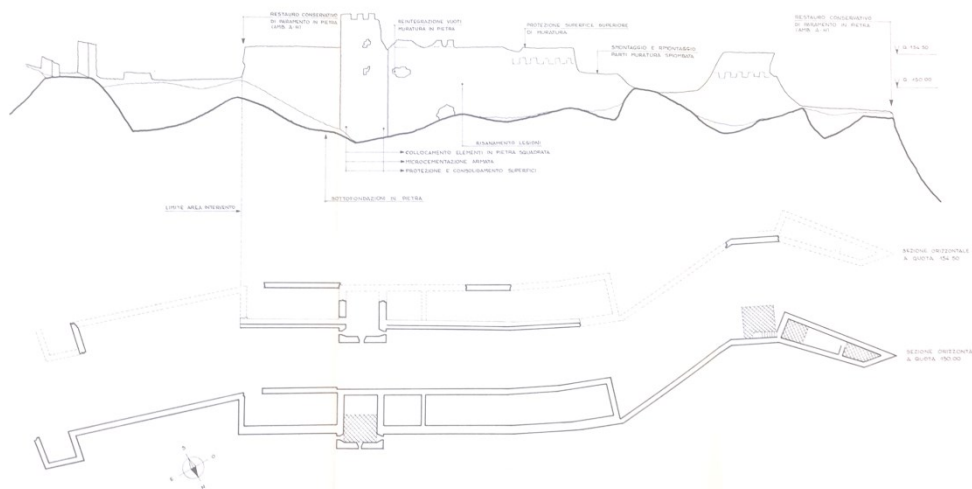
Elaborati di progetto con localizzazione degli interventi: sottofondazione in pietra, restauro conservativo dei paramenti, protezione e reintegro, microcementazione armata (ASBEAP_CA-OR)
